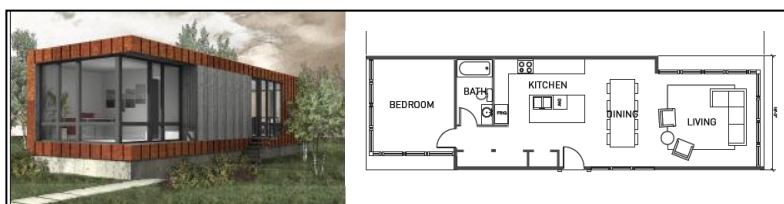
Elemental 1 – volume e planta baixa (www.methodhomes.net)
